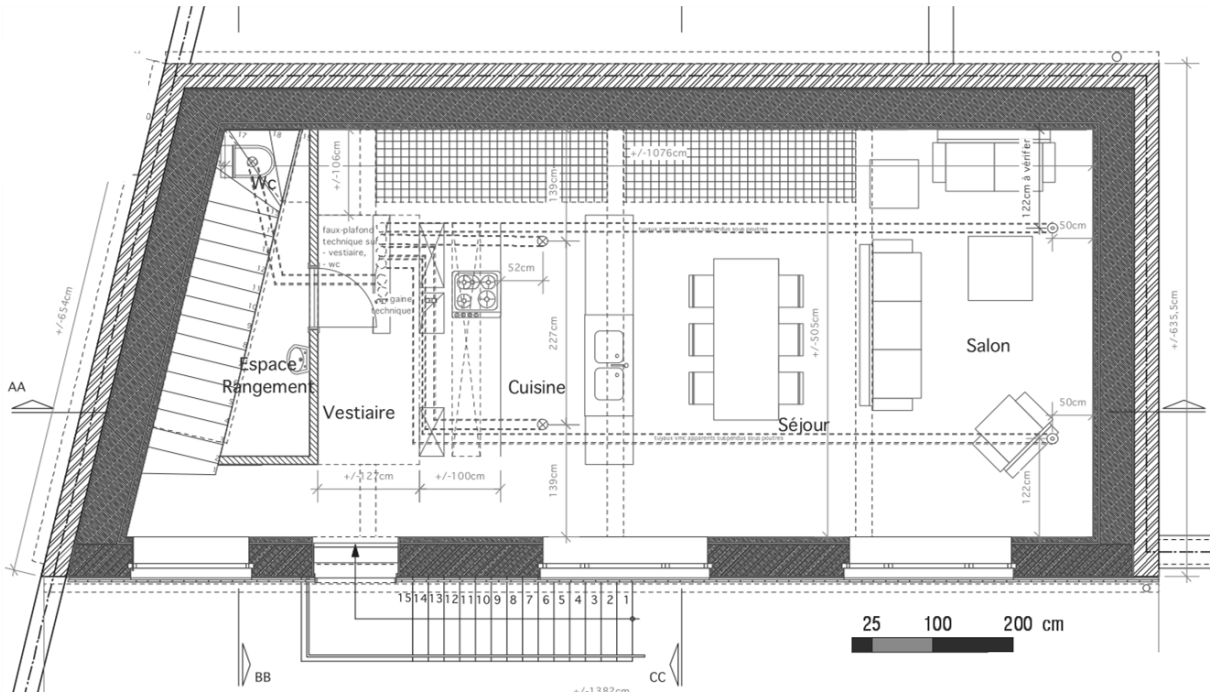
Plan du 1<sup>er</sup> étage (Source : Bureau Modelmo, 2010)
